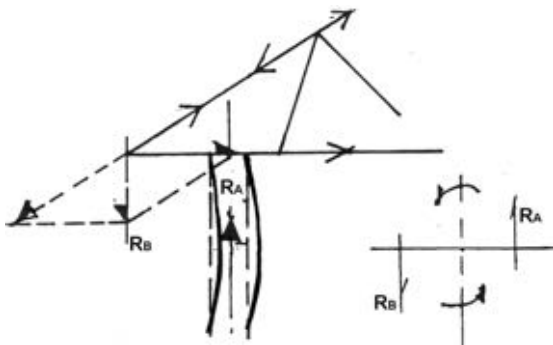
ROTACIÓN INTERIOR POR FORJADO
